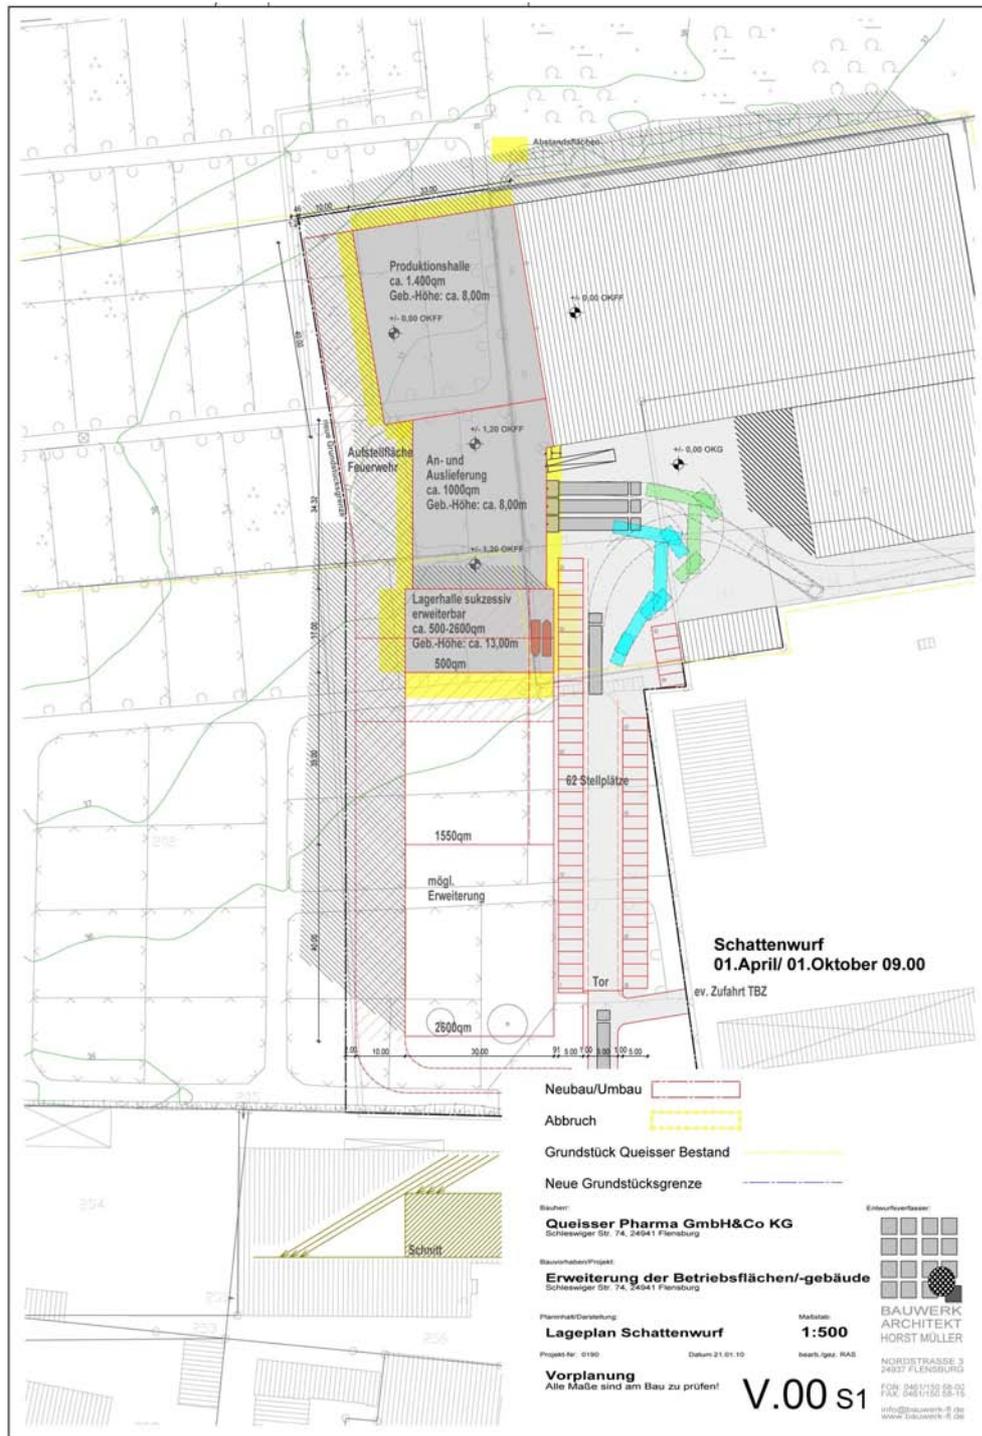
Lageplan des geplanten Gebäudes mit Schattenwurf im April und Oktober um 9.00 Uhr.
